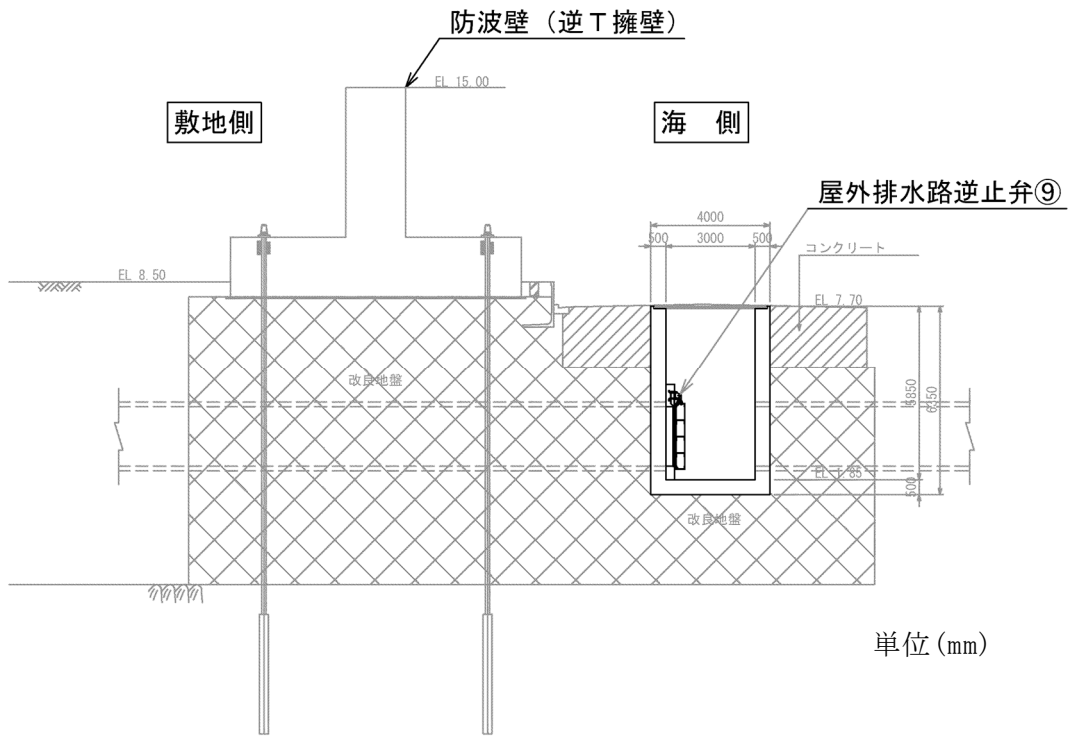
(2) 屋外排水路逆止弁⑨断面图
